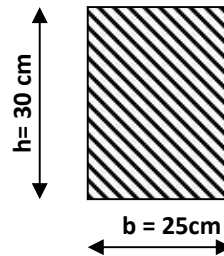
Les dimensions de la poutre de chaînage.
